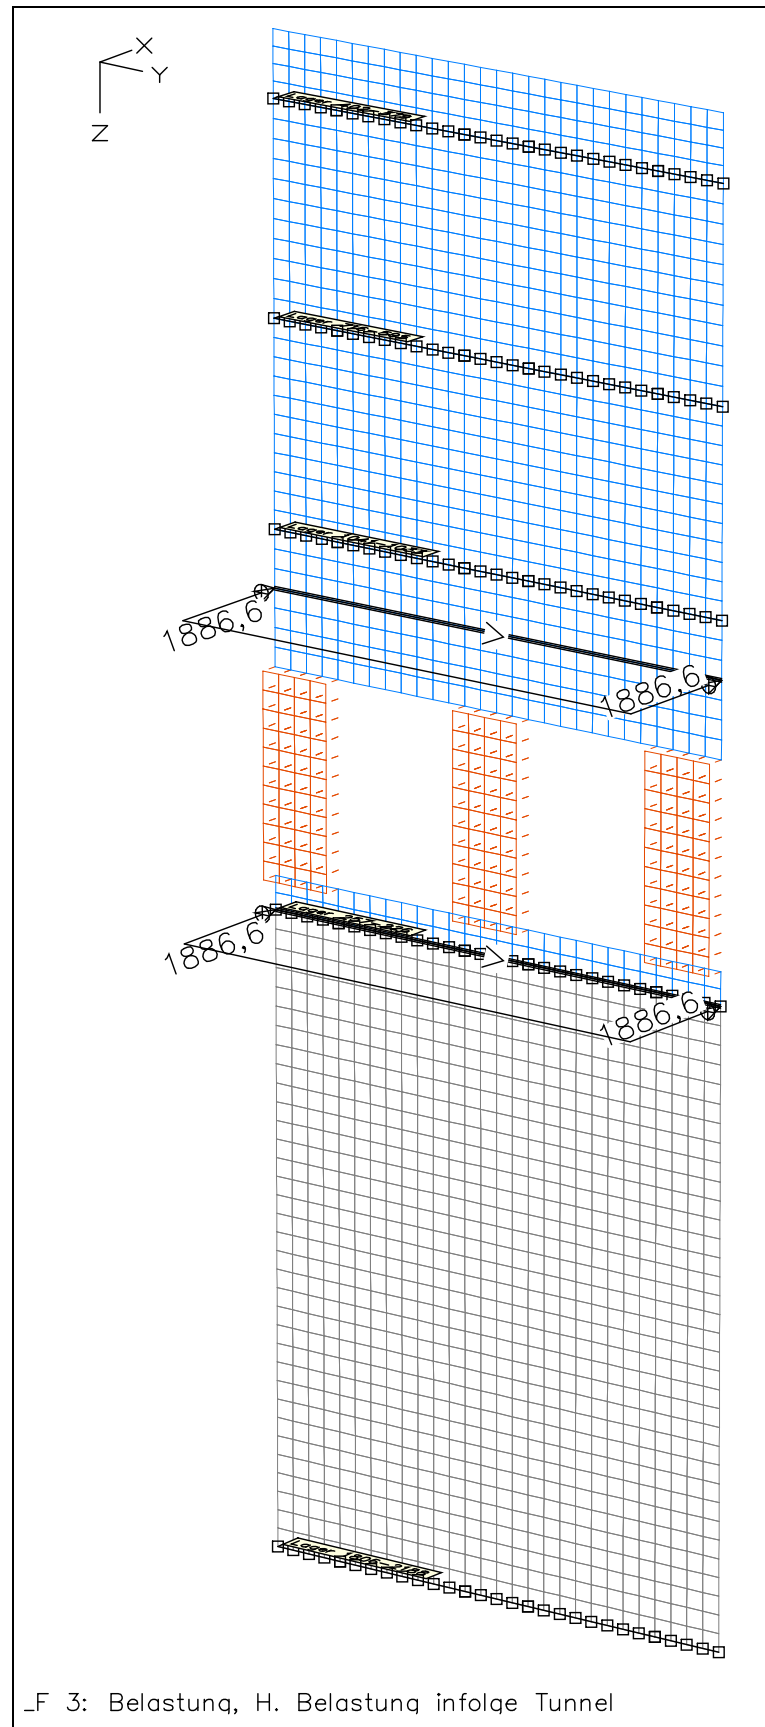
Lastfälle: 3, Horizontallast infolge des Tunnels
